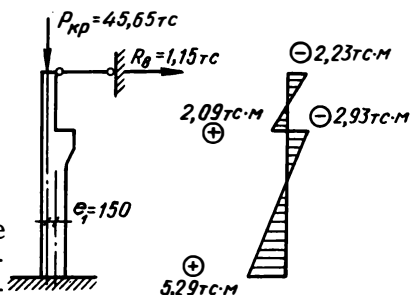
Расчетная схема и эпюра M от веса покрытия для колонны по оси A .
